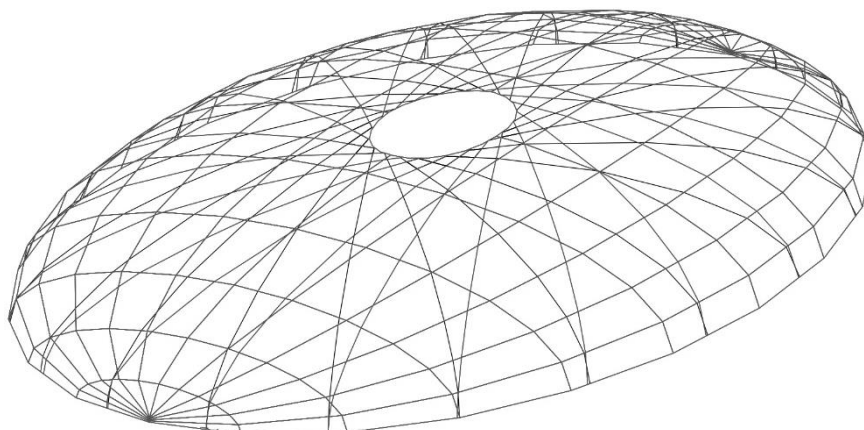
Introducción de la estructura en Autocad. Vista estructura alámbrica
